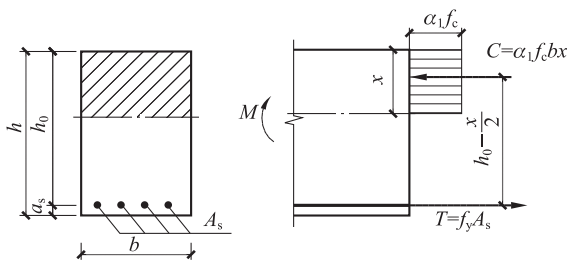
单筋矩形截面受弯构件的正截面受弯承载力计算图形
